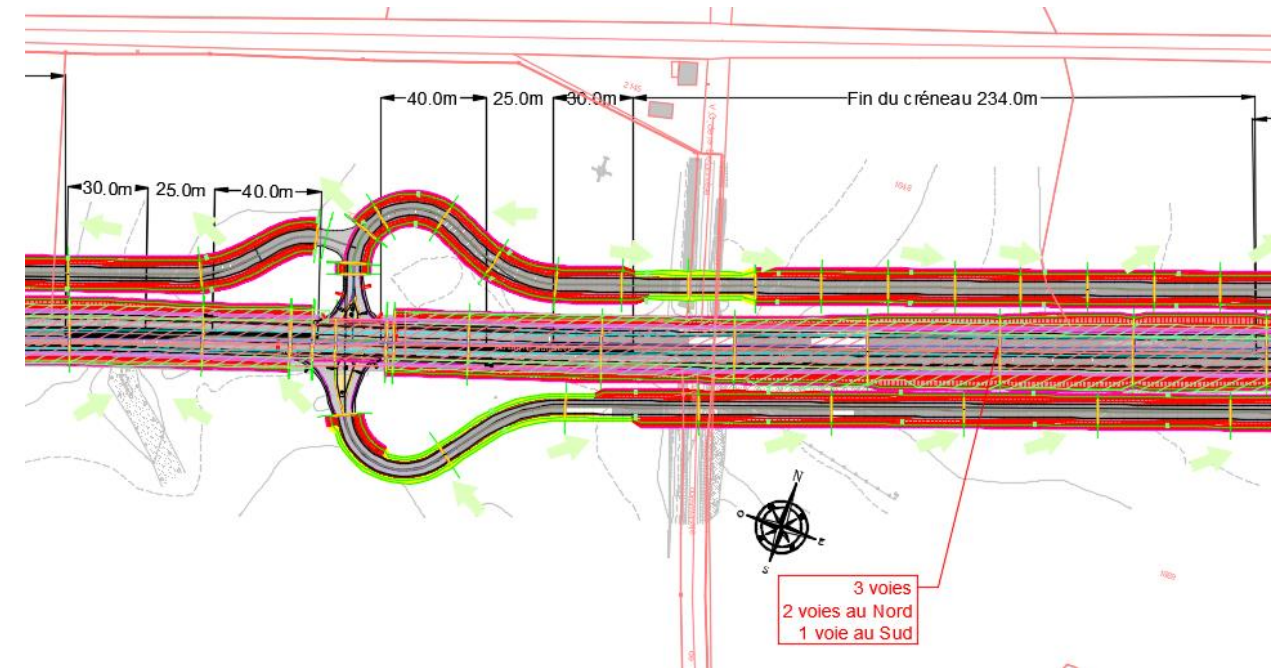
Plan du carrefour de Saint Eugène - Section 2
